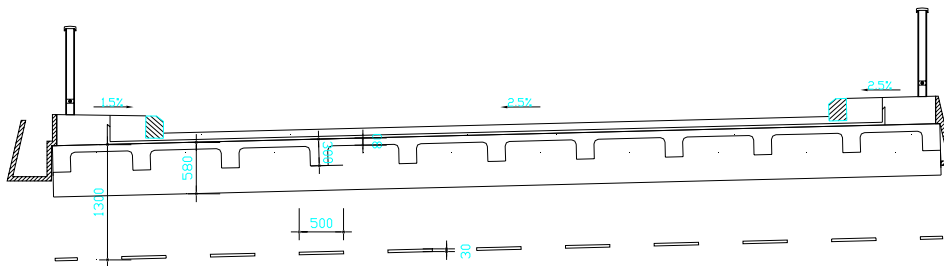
Coupe transversale - solution 25m - Dalle BFUP treillis et semelles en acier
